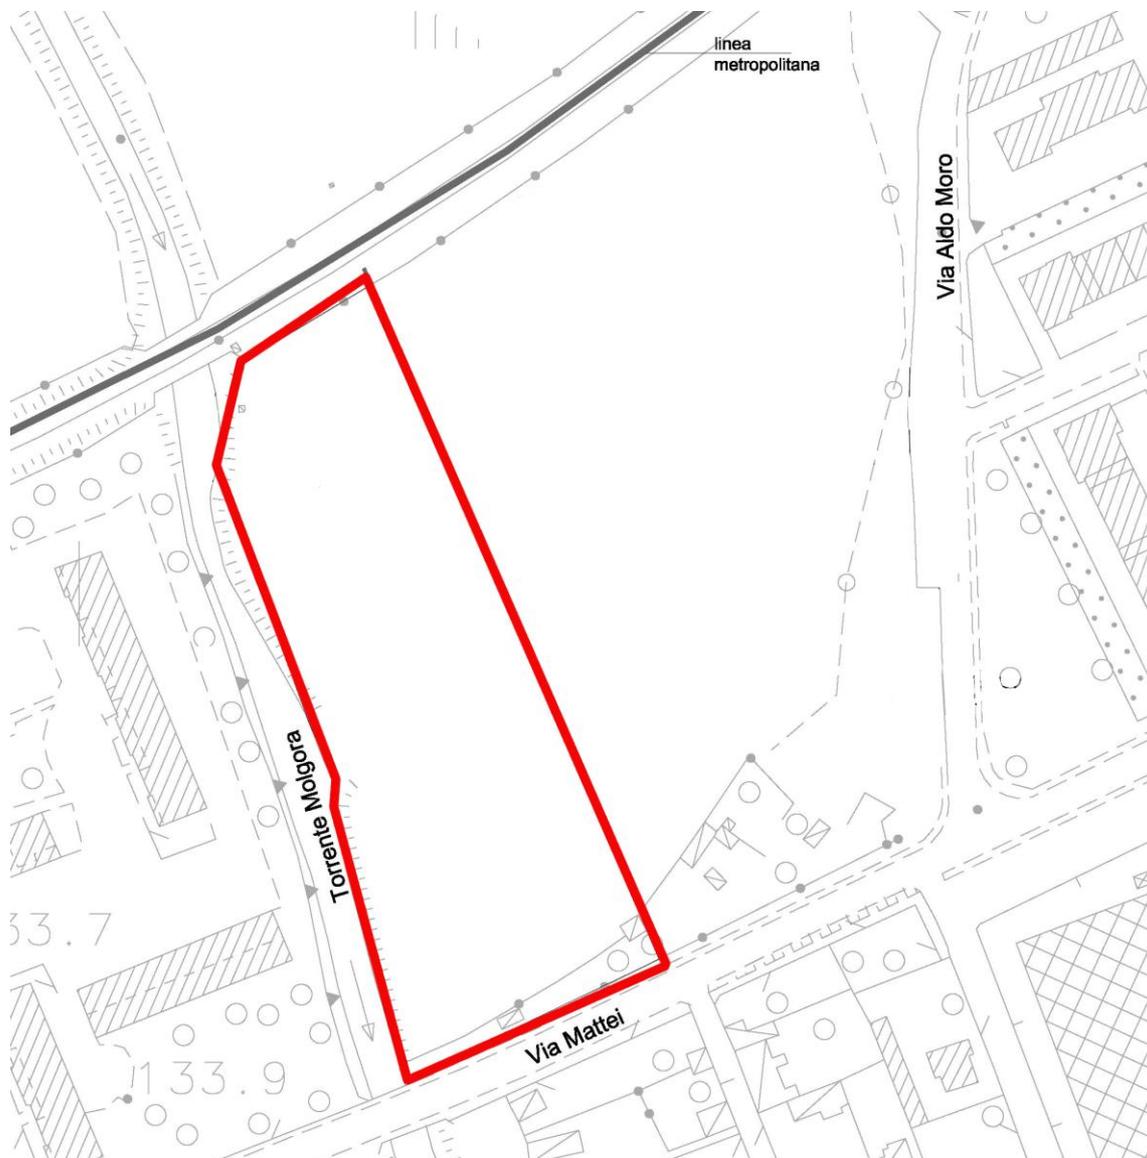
planimetria dell'area di progetto, evidenziata in rosso
